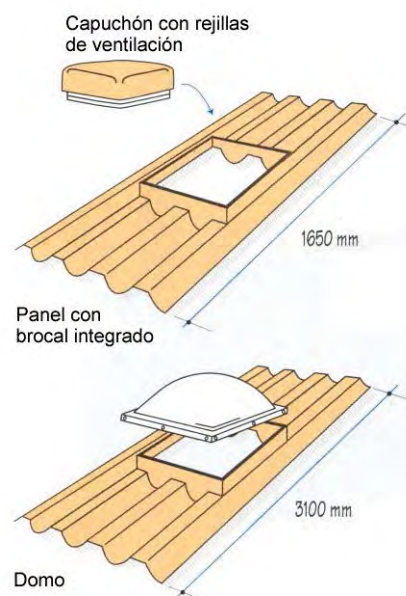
SALIDAS VERTICALES EN CUBIERTAS INCLINADAS DE TEJA
